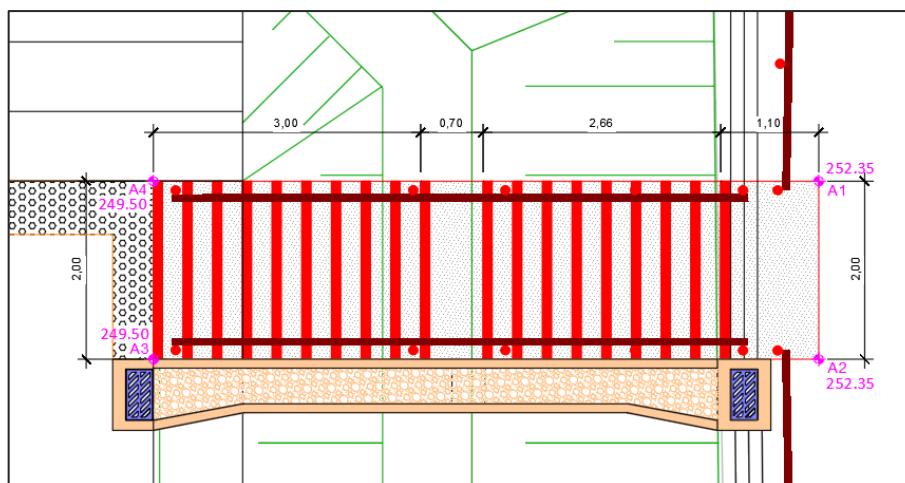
Vista en planta de las escaleras en el talud sur.
